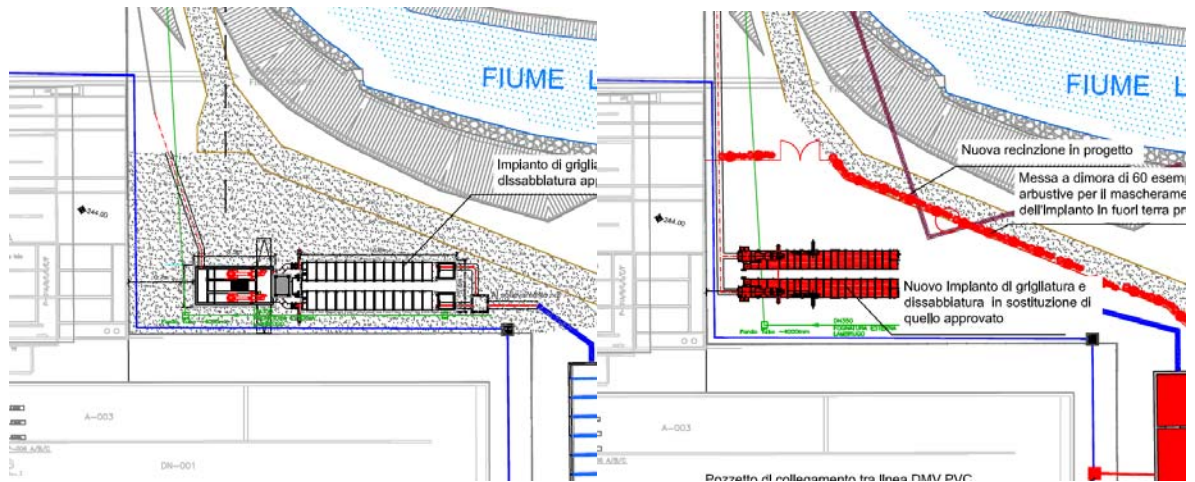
Collocazione impianto di trattamento, progetto approvato e variante
